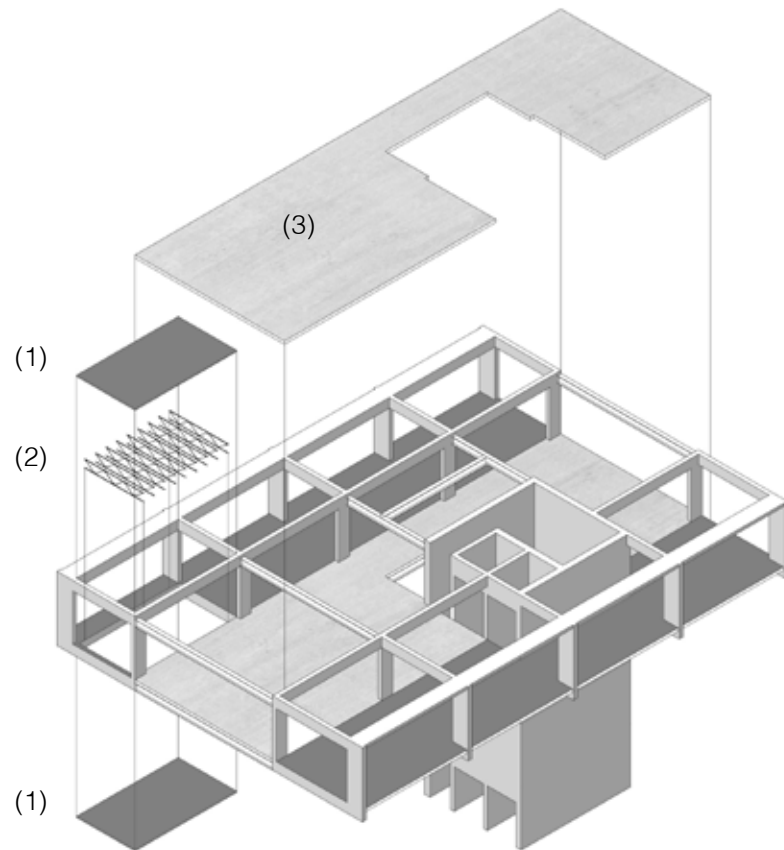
Perspectiva explodida da estrutura. (1) Painel Wall (2) Trelça metálica (3) Laje de concreto
